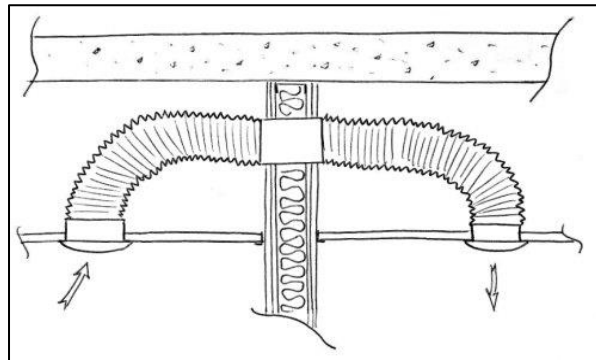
Schéma de principe de la mise en œuvre d'un transfert d'air à travers un plafond
